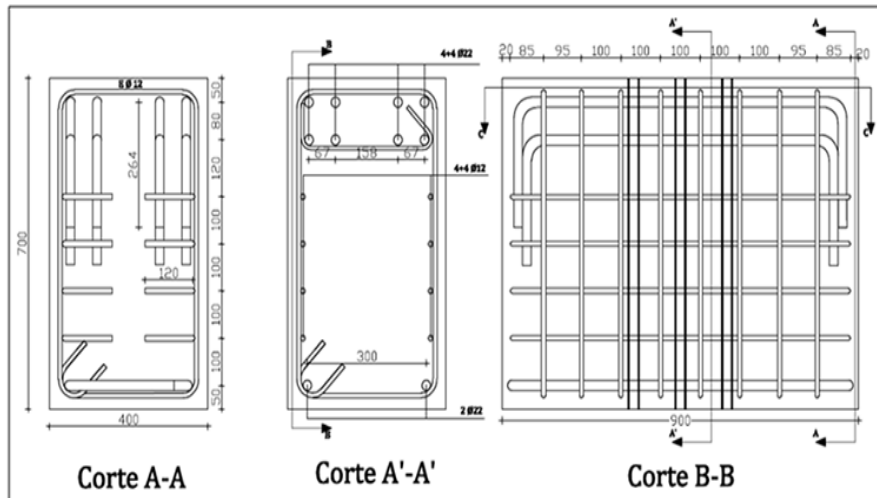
Planos de construcción pedestal para 6 barras longitudinales
